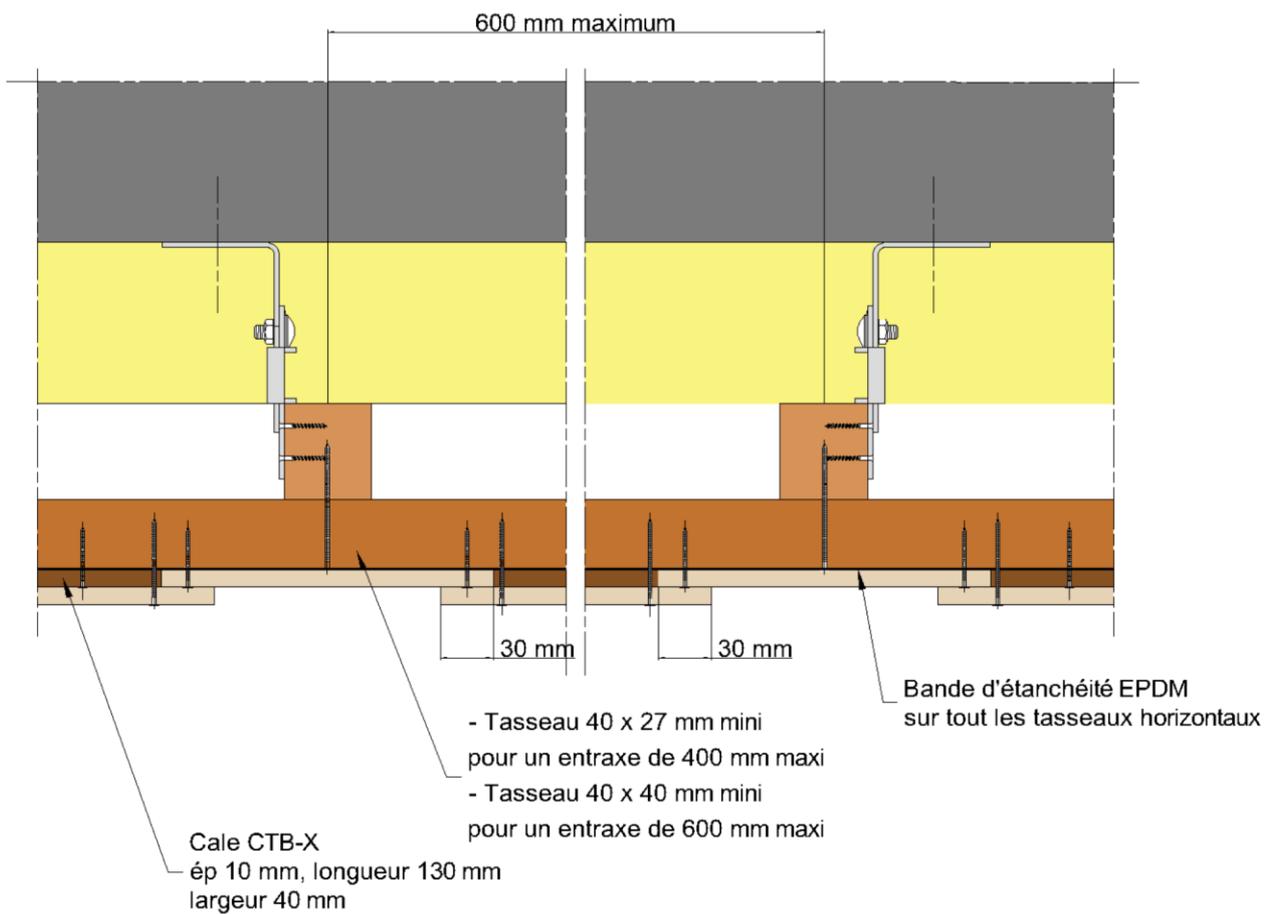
Coupe horizontale pose verticale CEDRAL LAP
